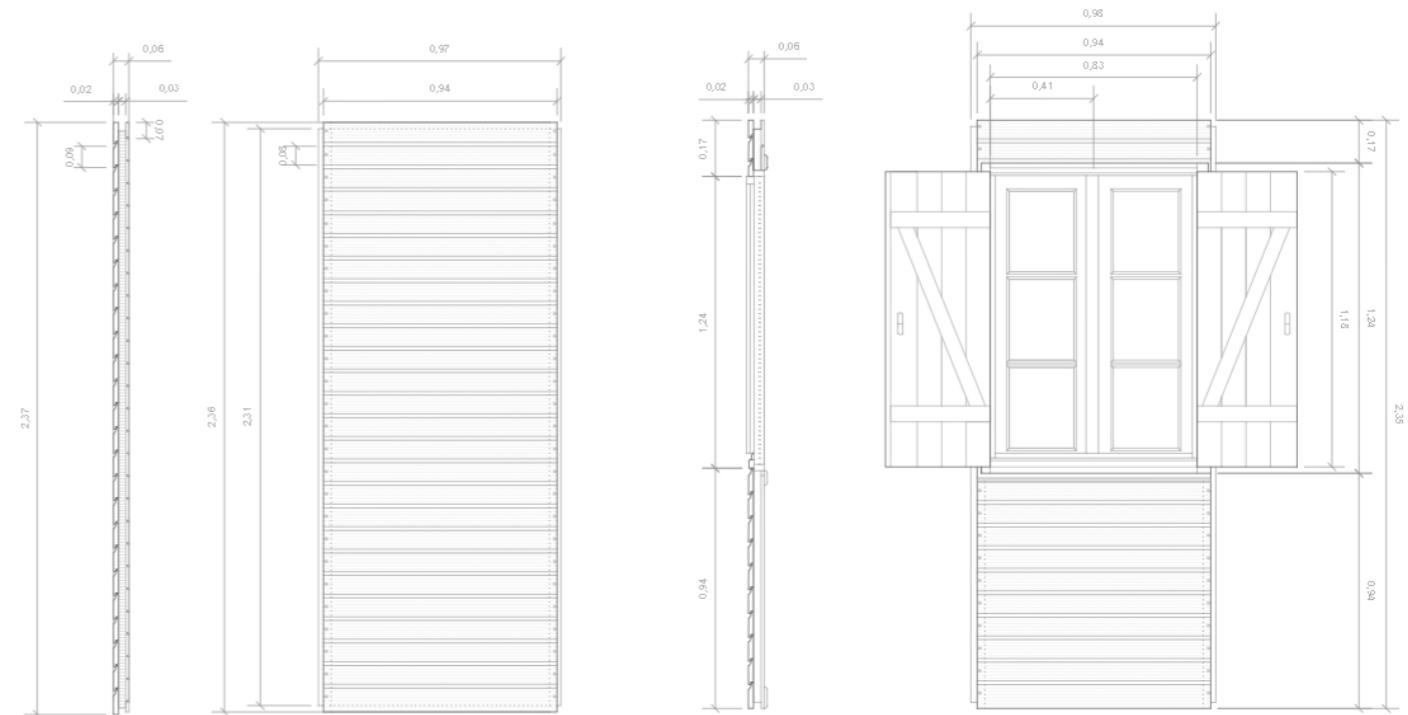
Detalle paneles de madera E:1/30. Elaboración propia.
